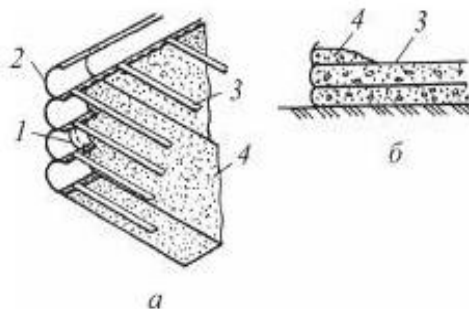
Армований ґрунт: *а* – конструкція армованої стінки; *б* – технологія влаштування; 1 – з'єднання внахлест; 2 – металевий елемент оболонки; 3 – арматура; 4 – ґрунт
